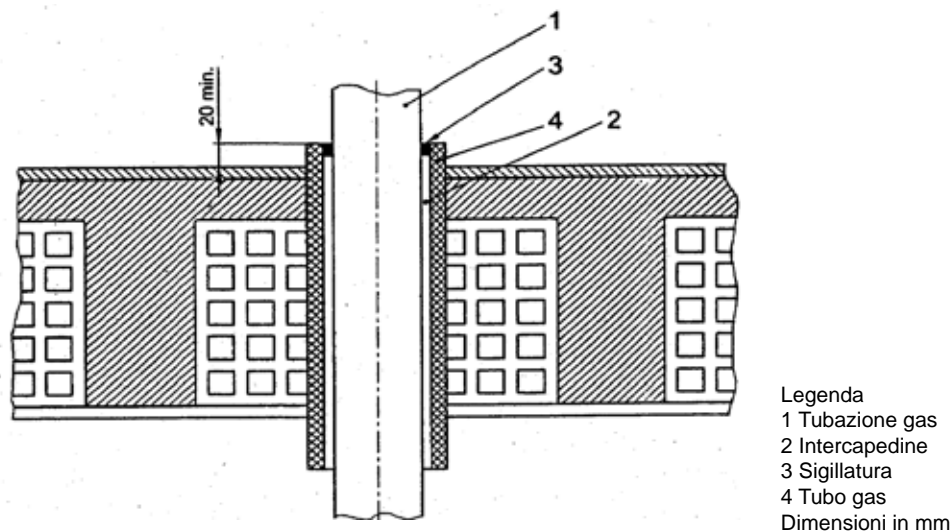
Attraversamento di solette (pavimenti o soffitti)
